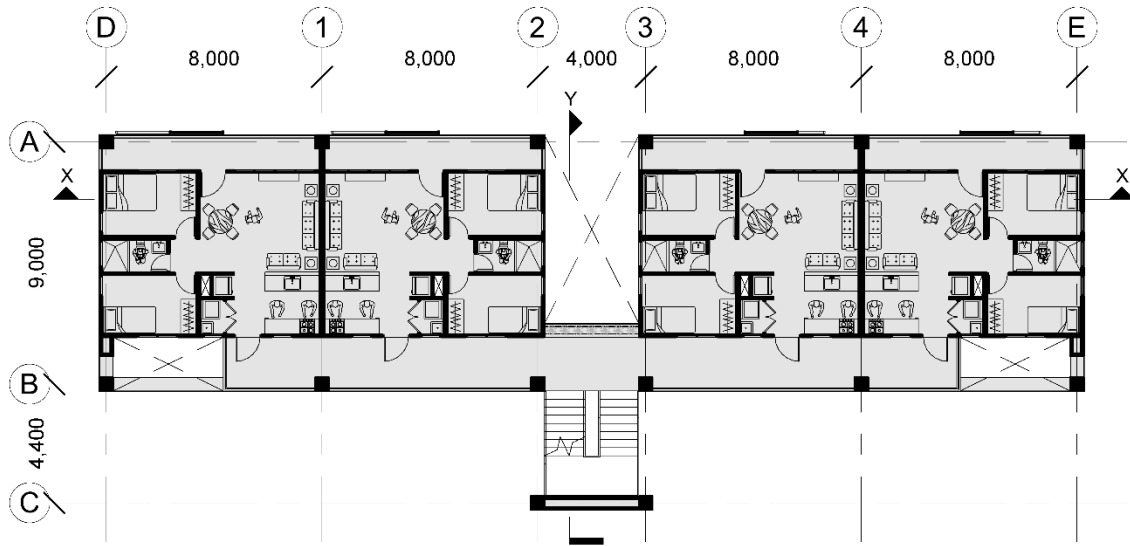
PLANTA ÁRQUITECTÓNICA EDIFICIO 2 | Elaborado por: El autor
